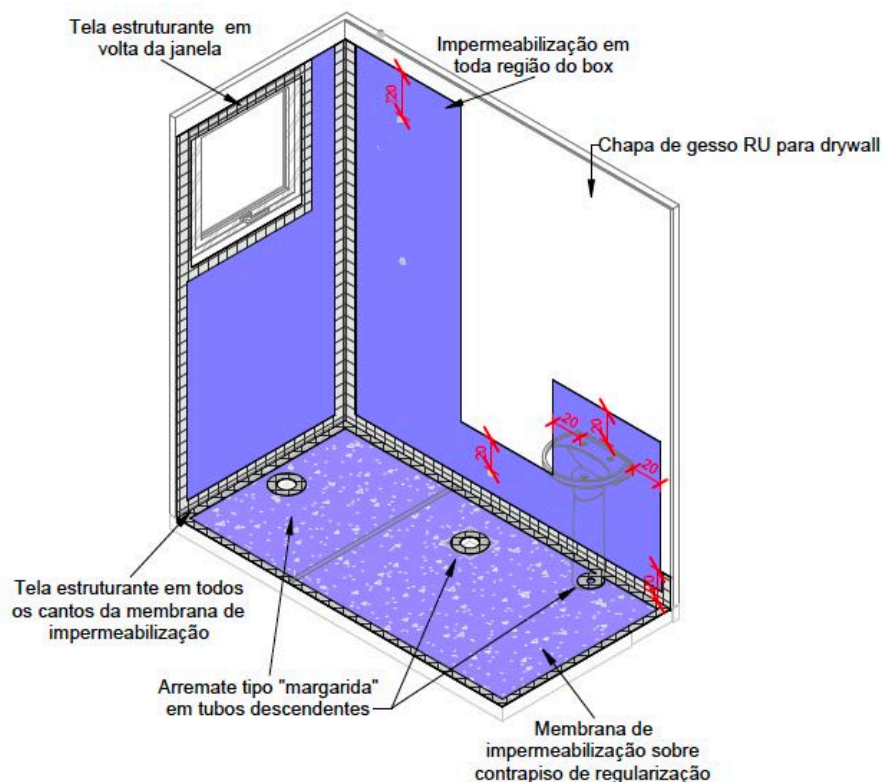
Desenho esquemático da impermeabilização do banheiro (área molhada).
